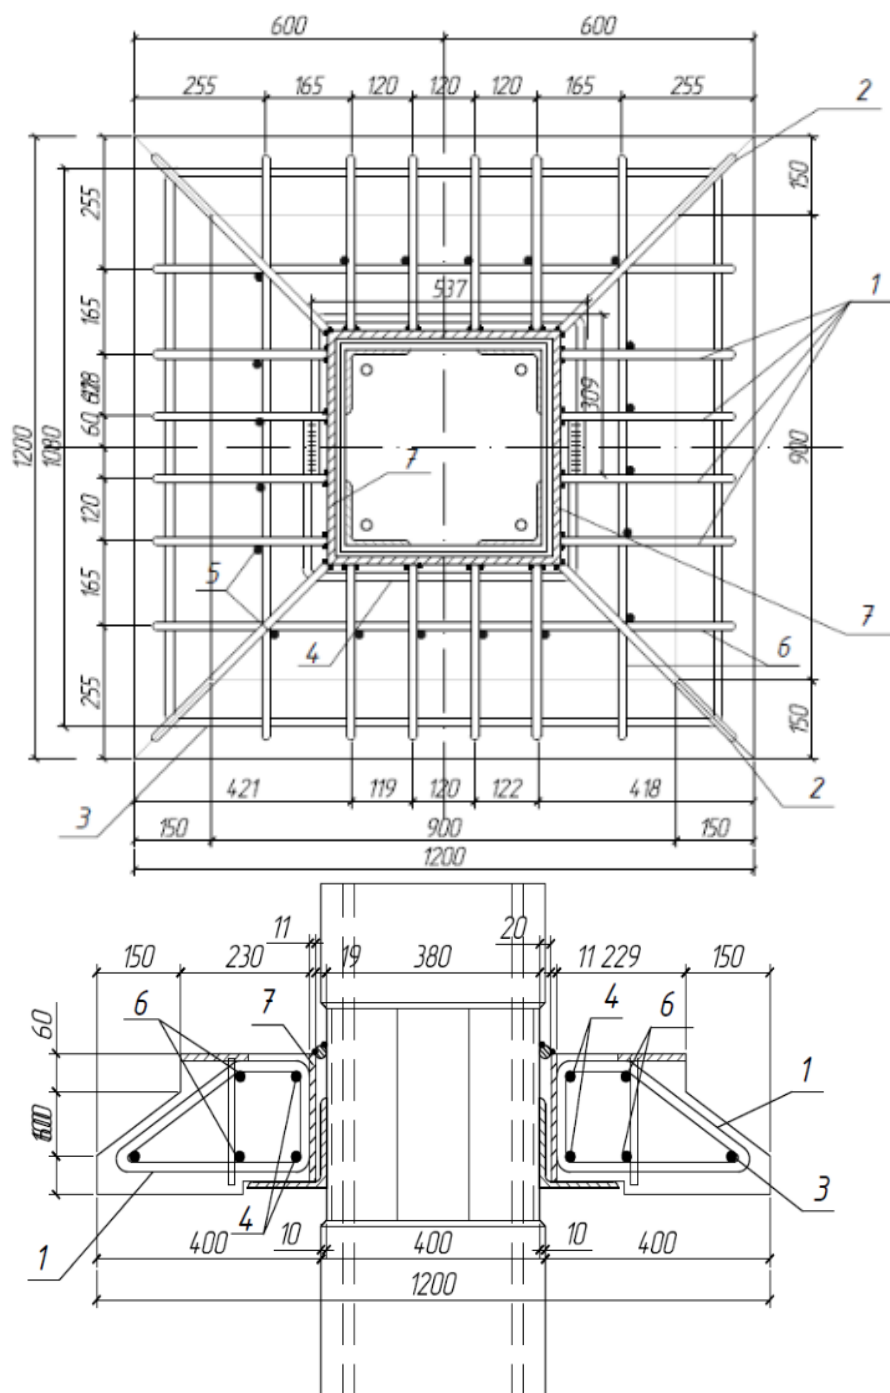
Армування надколонної плити (вид зверху та переріз):
